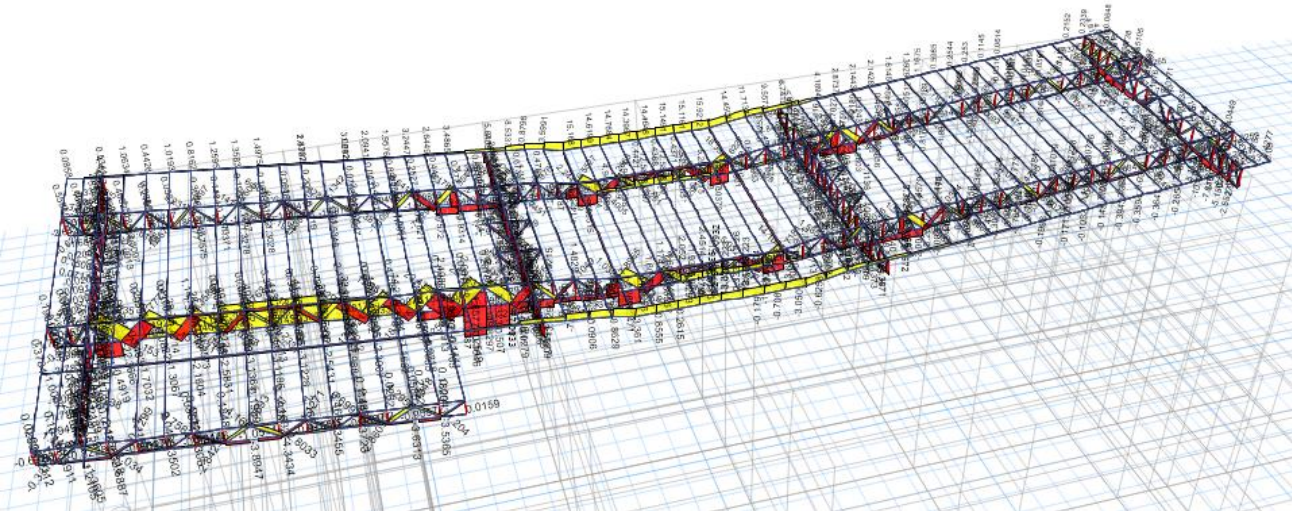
Elementos mecánicos (Axial) en estructura a base de armaduras.
